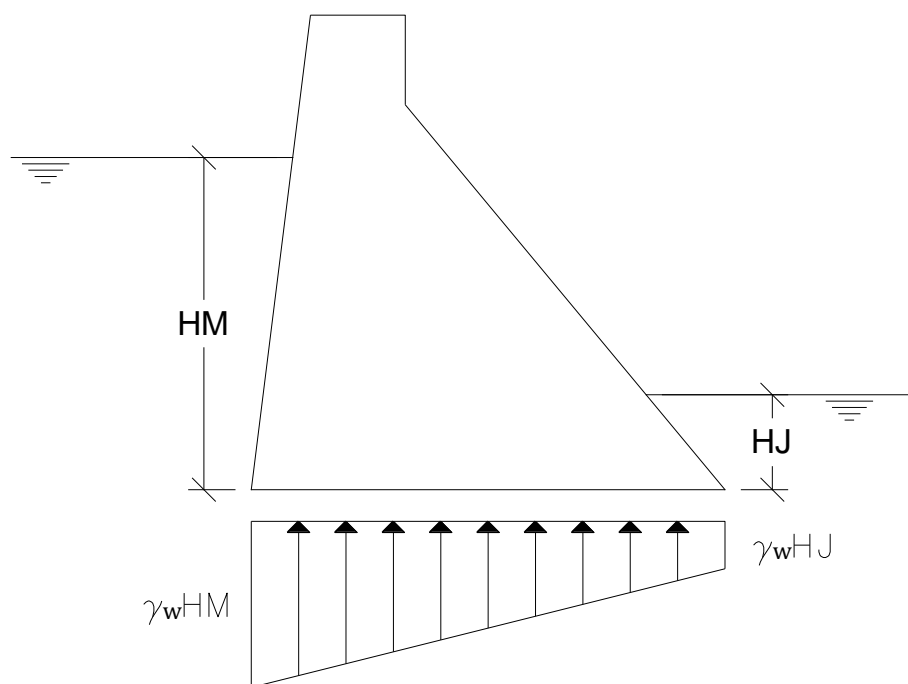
Ação da subpressão sem drenagem da fundação.
